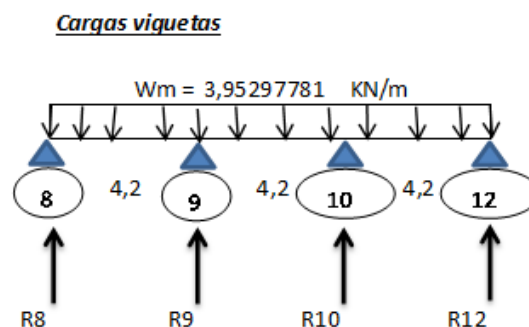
Modelo matemático de viguetas tipo 1, carga muerta actuante.
